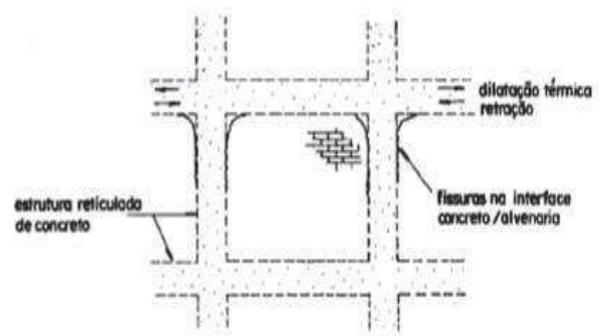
Trinca entre a estrutura e alvenaria.
